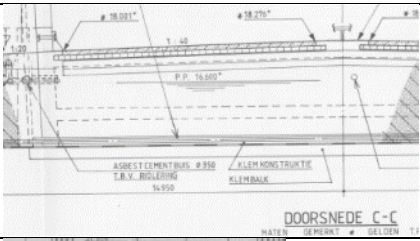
Langsdoorsnede westelijke toerit met verlengde betonnen bak en ingekorte folieconstructie (bron: tekening RWSON-2018-097942, RWSON-2018-097943 en RWSON-2018-097944).
